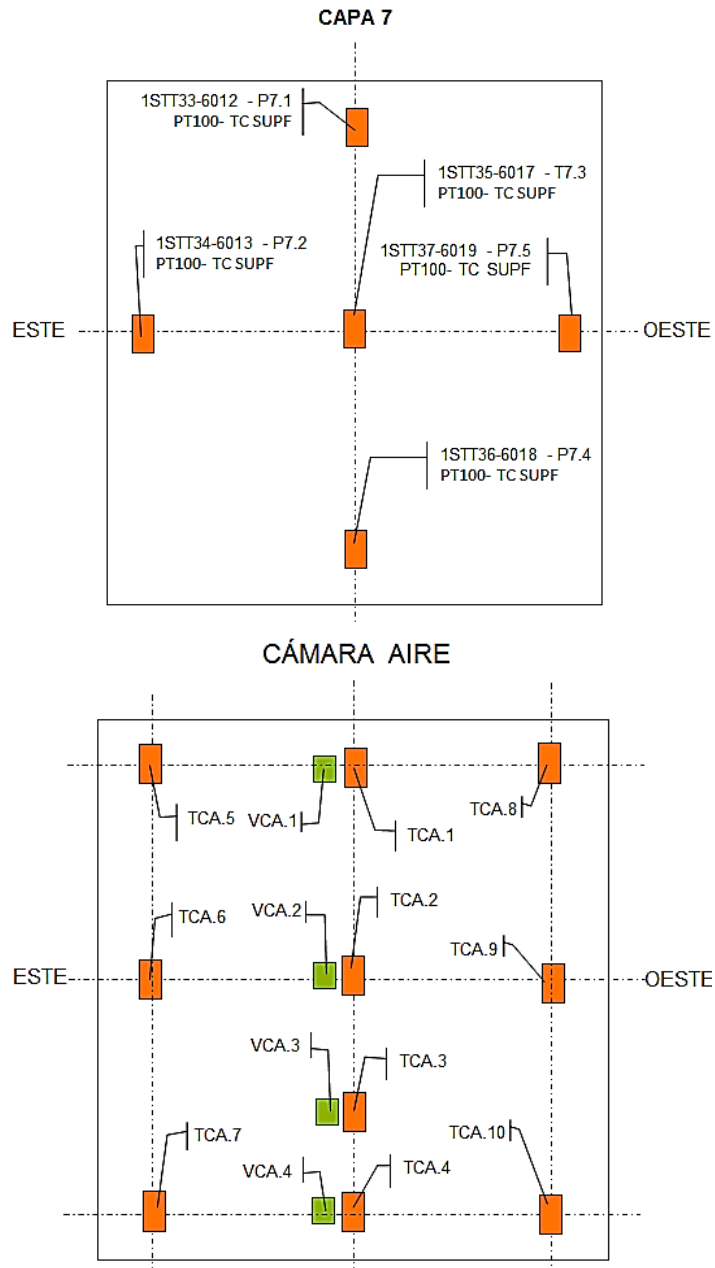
Instrumentación instalada en la fachada ventilada pesada
